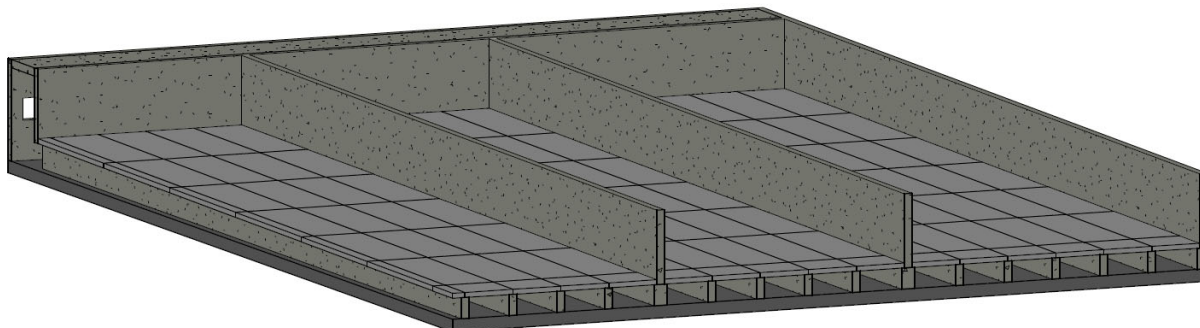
SCHEMA TIPICO DELLA STRUTTURA DEL BIOFILTRO
